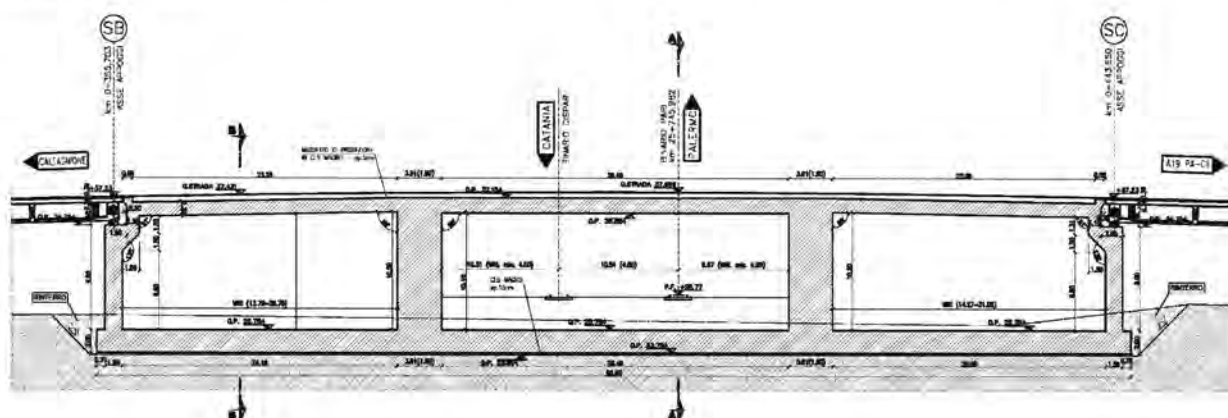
Sezione spalle SB ed SC
